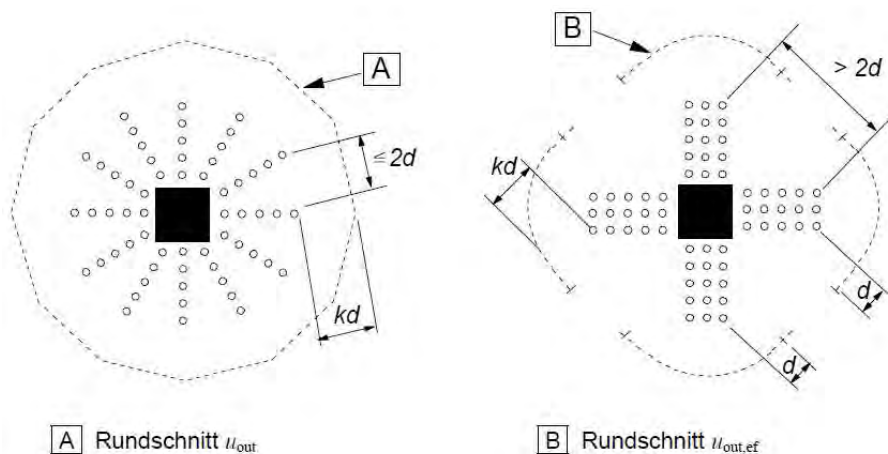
Layout der Durchstanzbewehrung aus Eurocode 2, Figure 6.22
